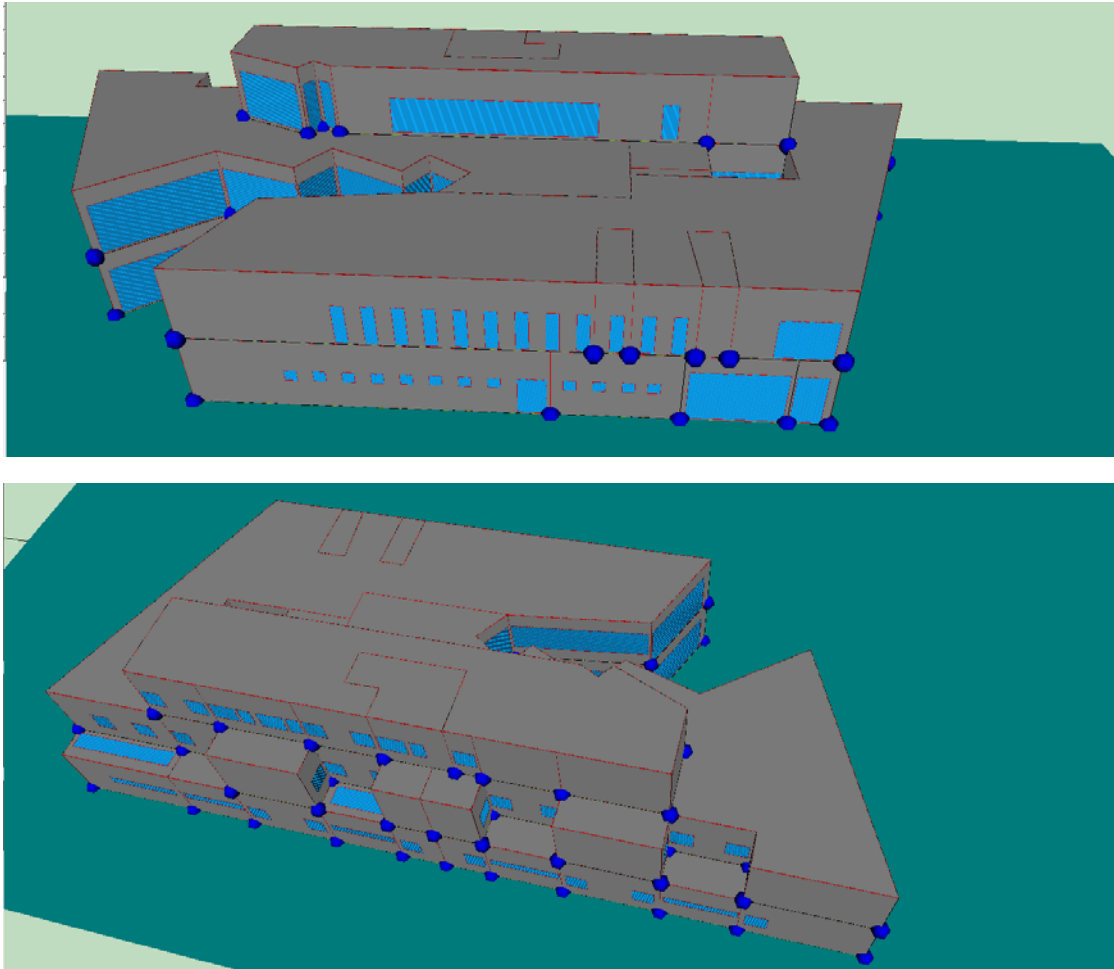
Vistas en 3D edificio en CALENER VYP.
